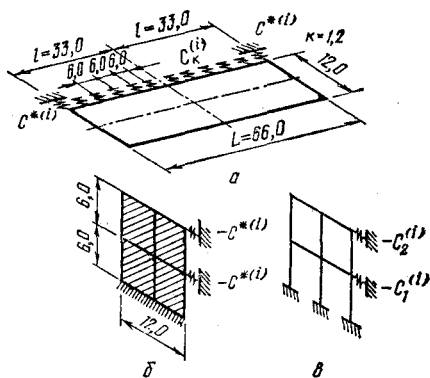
Расчетные схемы плоских элементов расчлененного здания: а — перекрытий; б — вертикальных диафрагм жесткости; в — поперечных рам.
